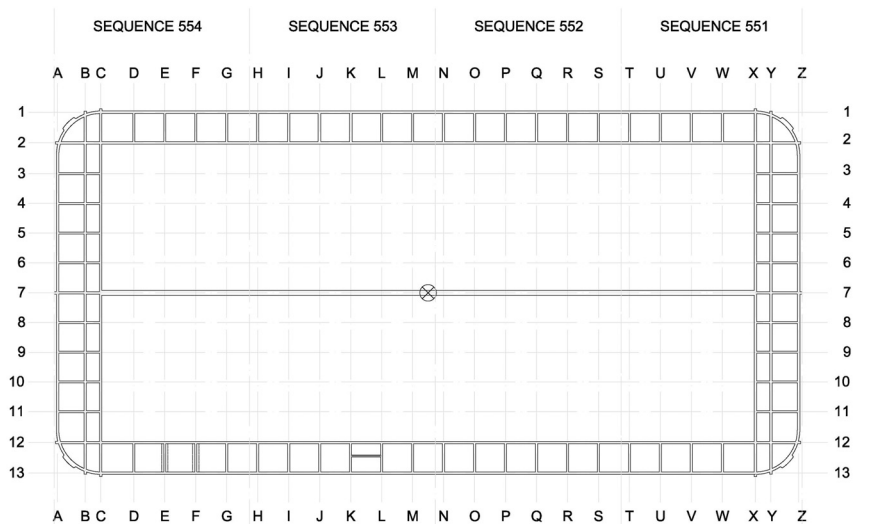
Sección horizontal de la estructura hasta la cota +46.50 desde nivel de dique seco. Doble casco alrededor de los tanques de LNG. Muros exteriores de hormigón armado y postensado de 0,6m de espesor.
